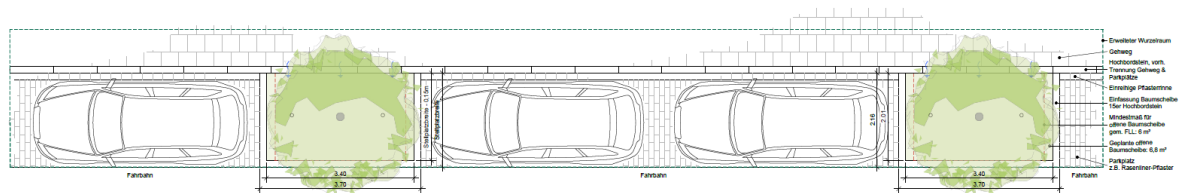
Offene Baumscheibe im Straßenbereich (Detail 3)
